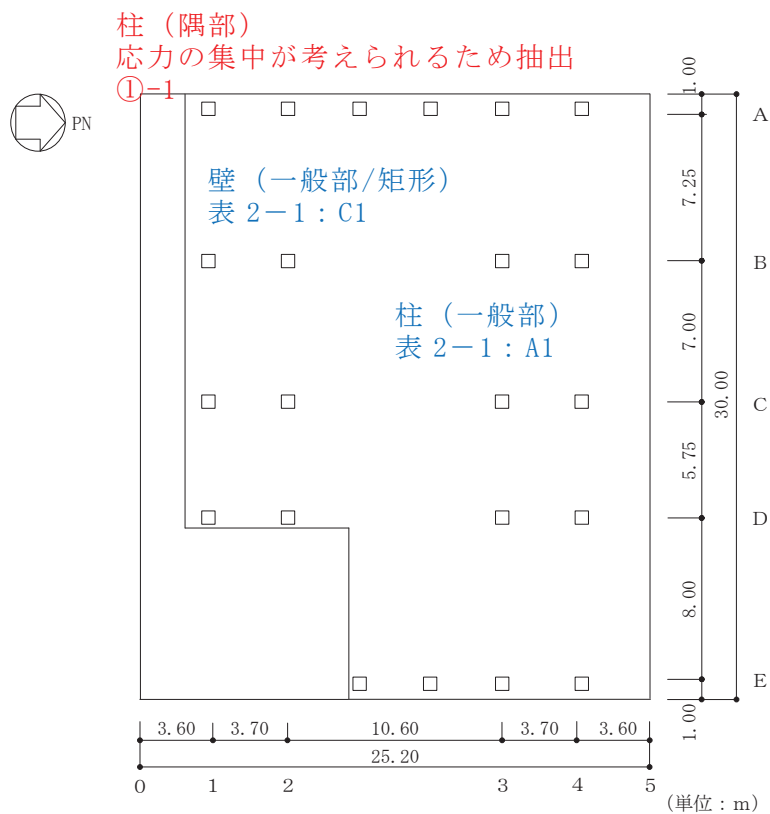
(2) 緊急用電気品建屋の概略平面図 (O. P. 62. 9m)
